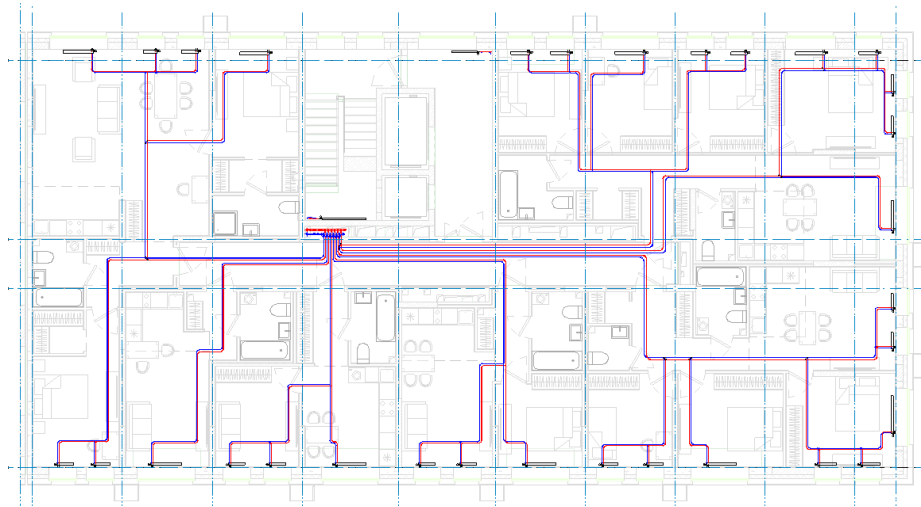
Разводка системы отопления типового этажа многоэтажного жилого дома
